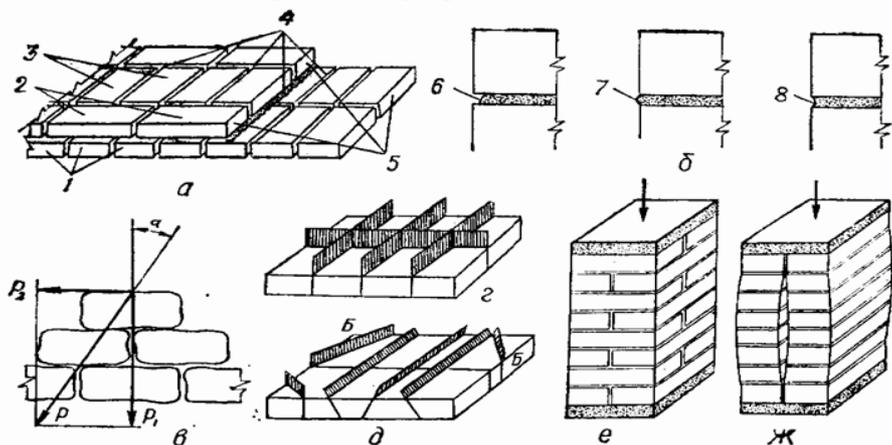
Элементы кладки и правила разрезки: а - элементы кладки; б — расшитые швы; в — воздействие на кладку наклонной силы; г — правильное и д — неправильное расположение плоскостей разрезки; е — кладка с перевязкой швов; ж — кладка без перевязки швов; 1 — тычковый ряд; 2 — ложковый ряд; 3 — забутка; (2 и 3 — постели); 4 — швы; 5 — версты (внутренняя и наружные); 6, 7, 8 — швы (неполный, выпуклый и вогнутый).
